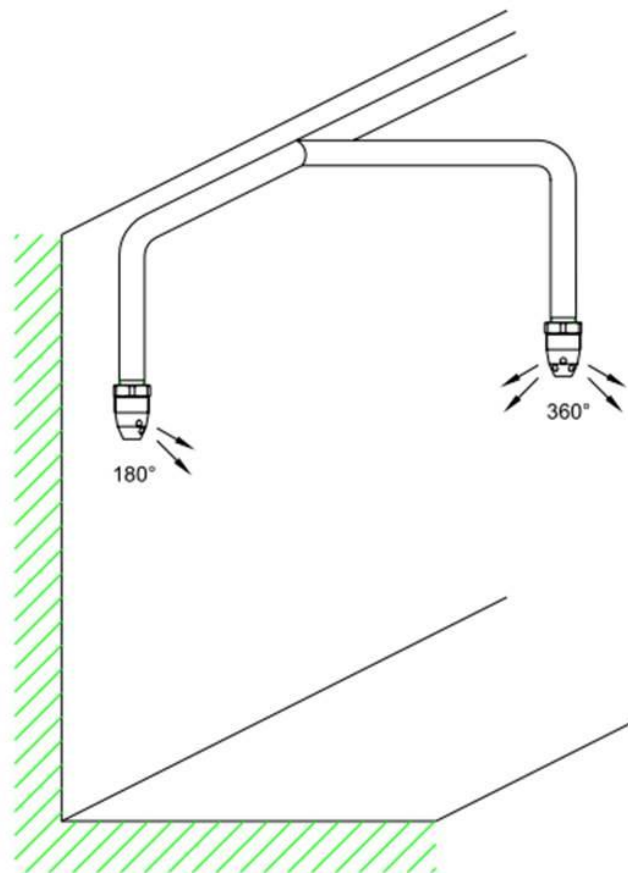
Posicionamiento de las boquillas de descarga
